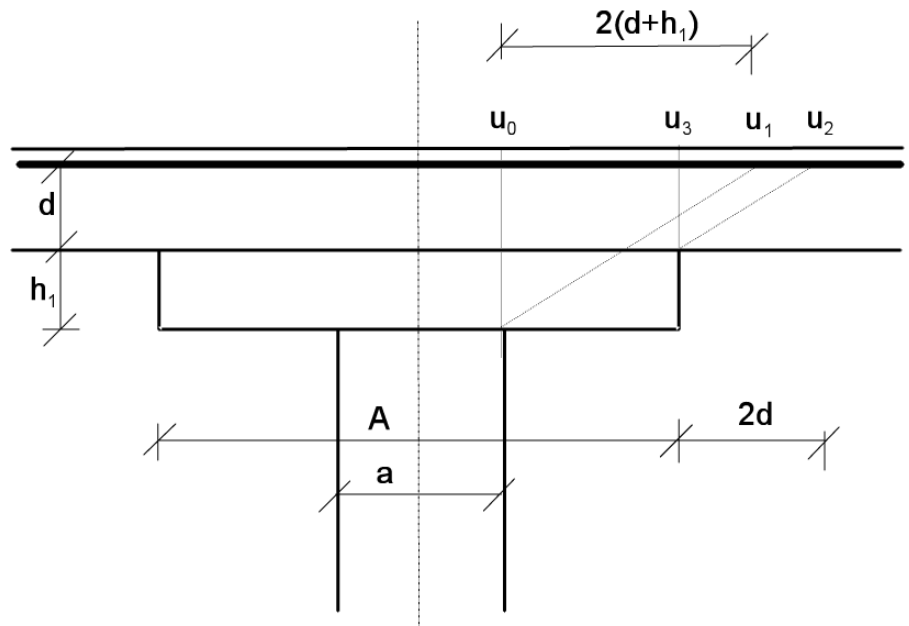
Plancher-dalle avec chapiteau. Contours de calcul
